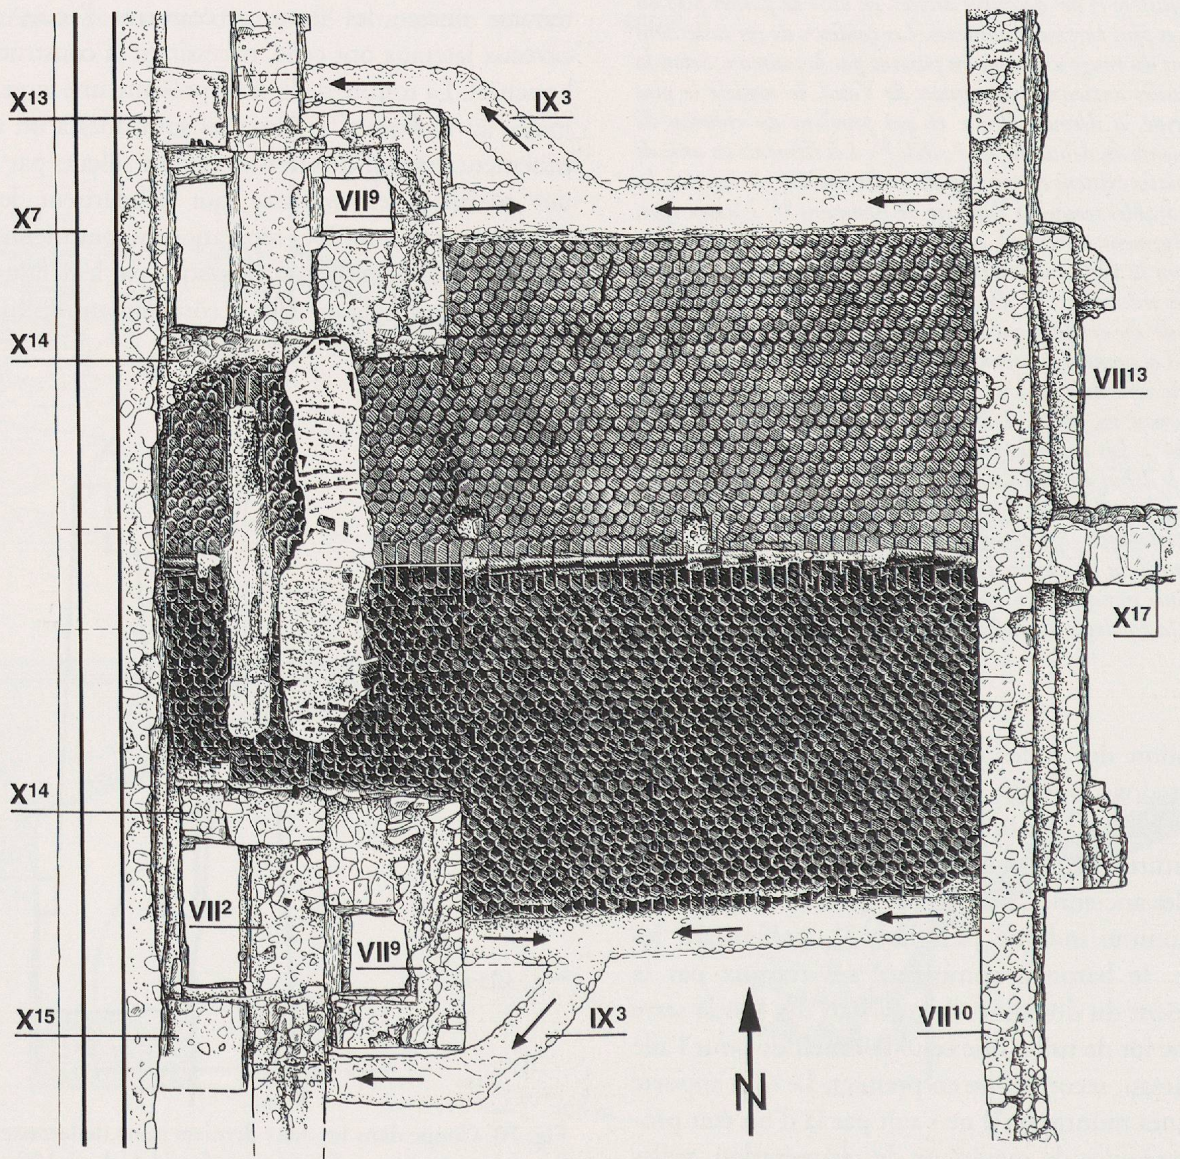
Plan de détail de la serre souterraine (éch. 1:100).
